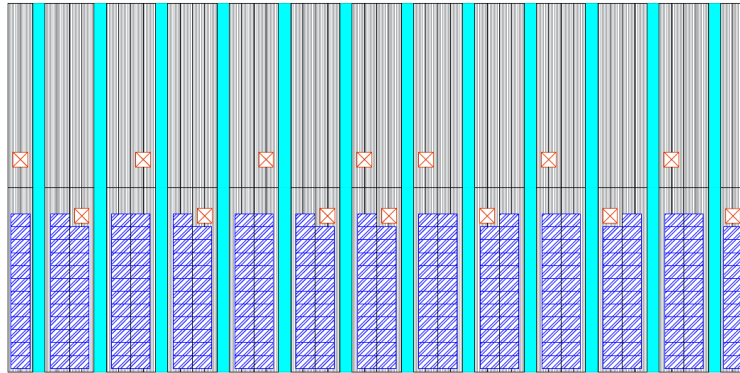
Distribución paneles fotovoltaicos en cubierta. Documento III-Planos
